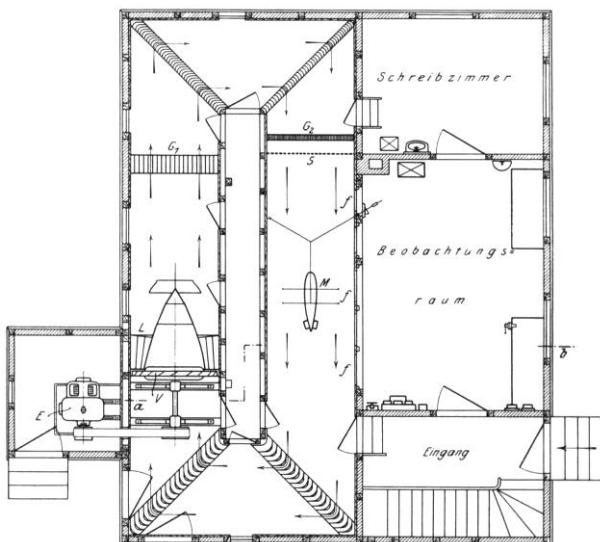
Grundriss des ersten Windkanals mit geschlossenem Kreislauf in Göttingen nach [8]; Entwurf von L. Prandtl.
